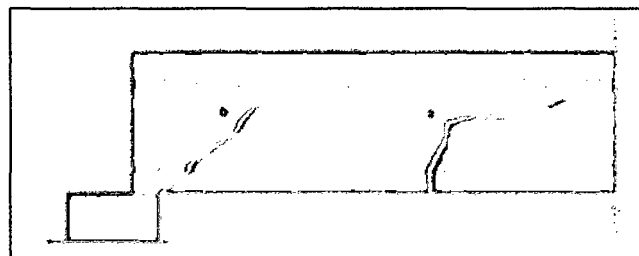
8. a) Fisuración por agotamiento de la armadura transversal de tracción b) Fisuración por combinación de cortante y flexión. Fuente: (Stuardo P., 2008).
